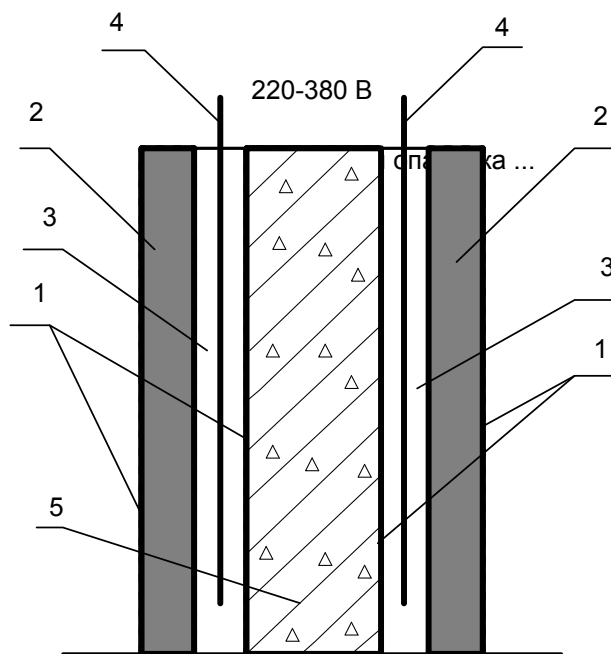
Общий вид опалубки для бетонирования - каркас;
